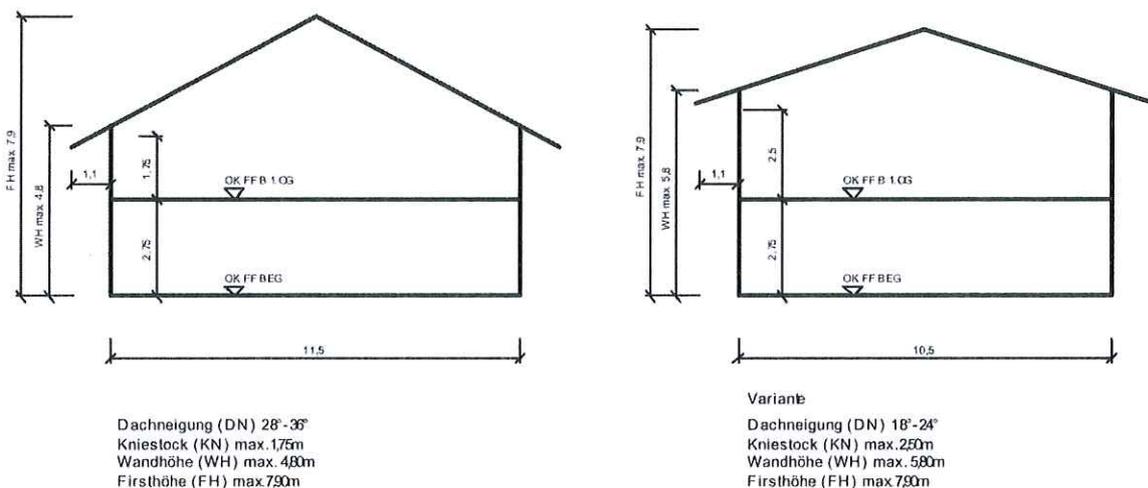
Dachausbildung Variante A und Variante B, siehe auch Anlage 3 – Hinweise zur Gestaltung von Dachaufbauten
